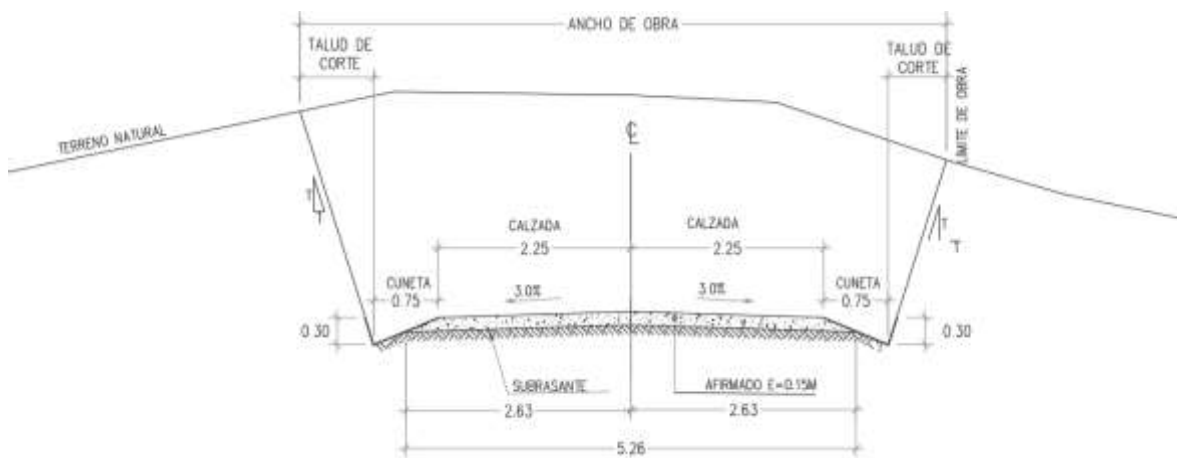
Sección típica en corte cerrado. Fuente: Plano de secciones típicas
